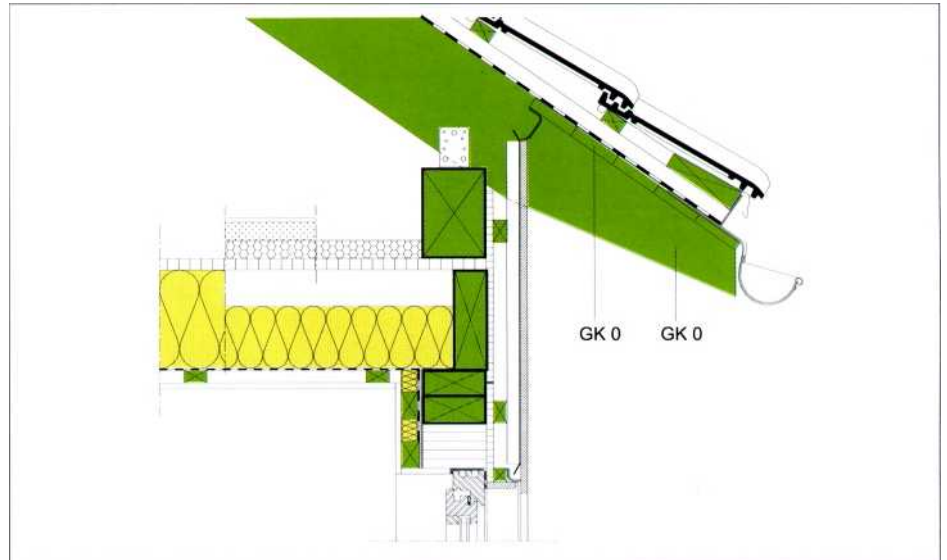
Beispiel für Situation von Decken unter nicht ausgebauten Dachgeschossen und Möglichkeiten für oberseitige Abdeckung: Ohne Deckenauflage, mit Deckenauflage aus Dämmschicht ohne / mit zusätzlichem Gehbelag (Estrich, Plattenwerkstoff)
